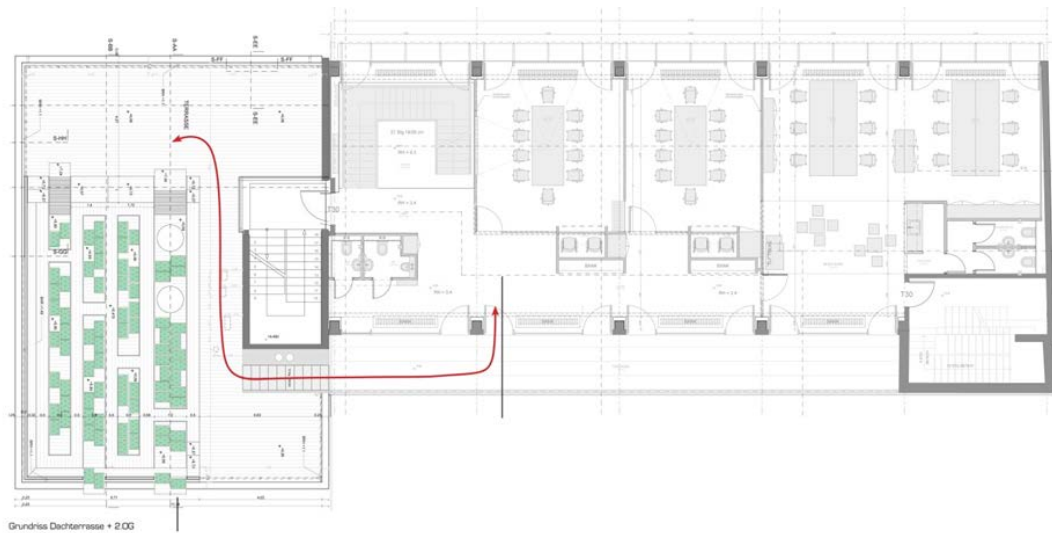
Grundriss 2. Obergeschoss
